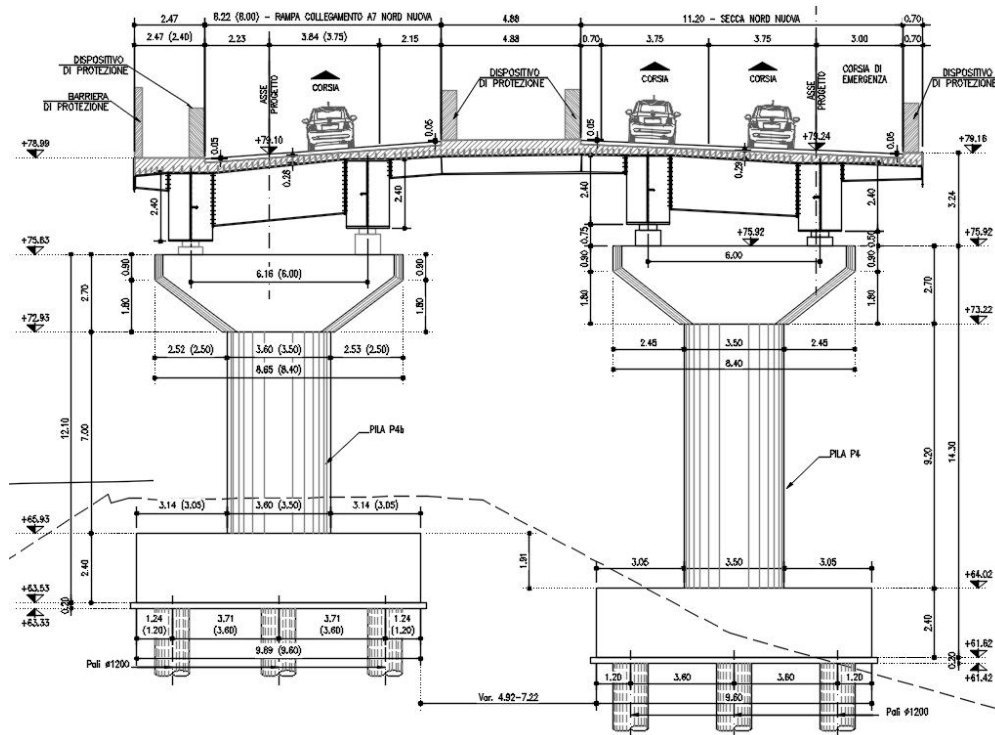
Pila a mensola - Sezione trasversale Pila P4
